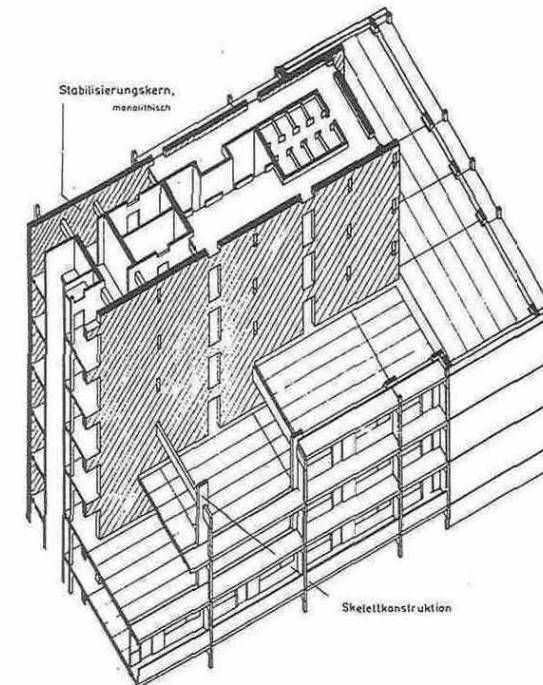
Konstruktionssystem mit Treppenhaukern
